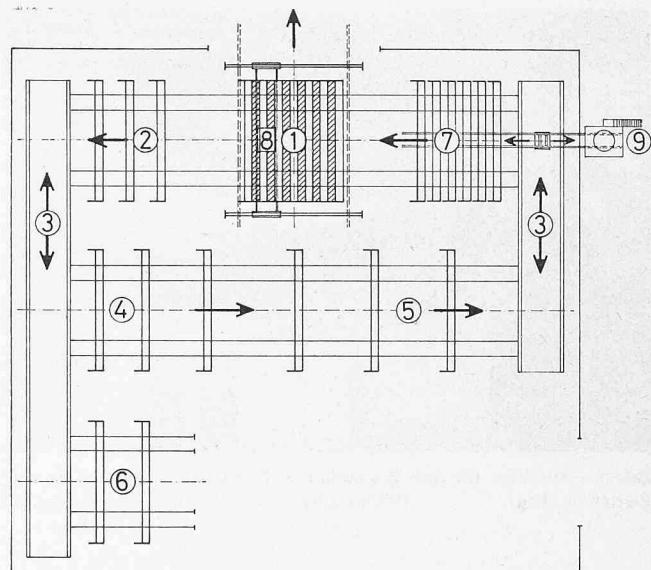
Vertikale Fabrikation im Umlaufverfahren. 1 Betonieren, Vibrieren, Heizen, 2 Schalung Reinigen, 3 Querverschiebung, 4 Einschalen, 5 Armieren, 6 Umstellungen (Langsamläufer), 7 Bereitstellung, 8 Betonverteiler, 9 Betonaufbereitung
